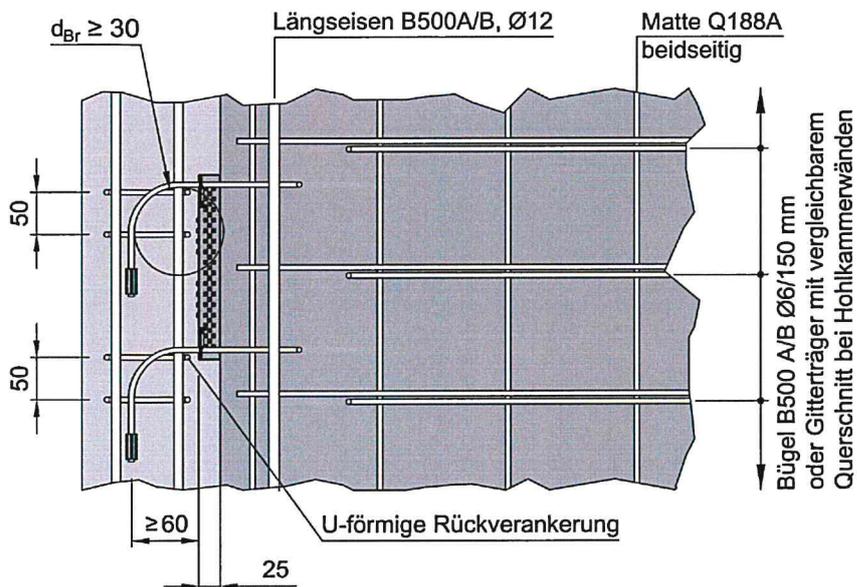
Eckverbindung mit abgewinkelten Seilschlaufen, Abmessungen, Bewehrung
